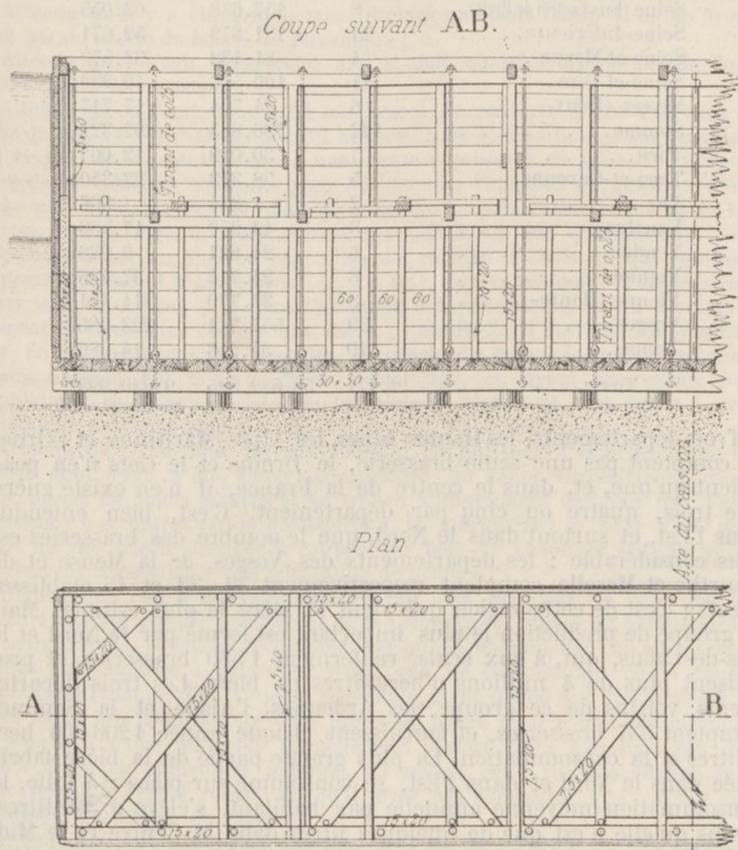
et 5. — Coupe et plan du caisson démontable.
